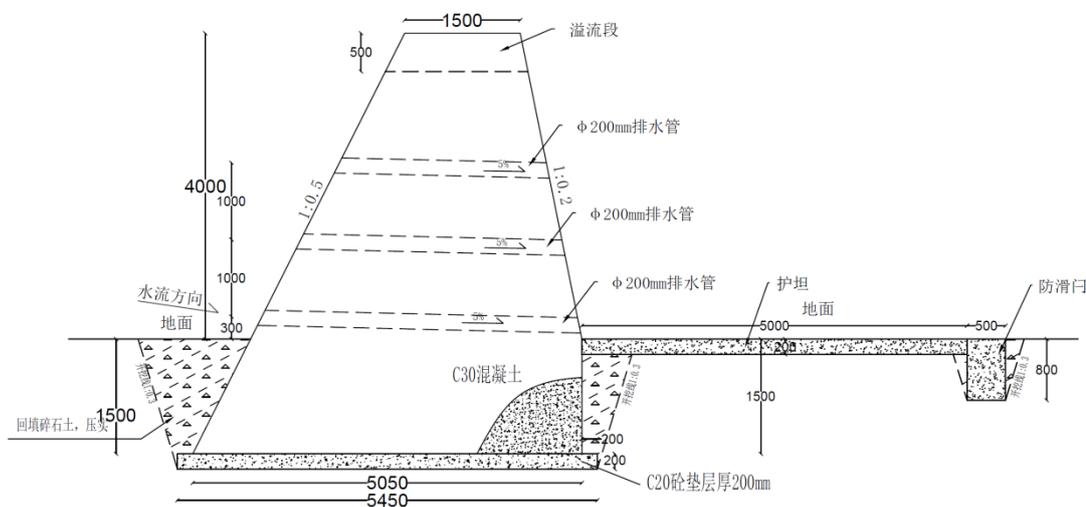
I 型拦挡坝断面图 (mm)
